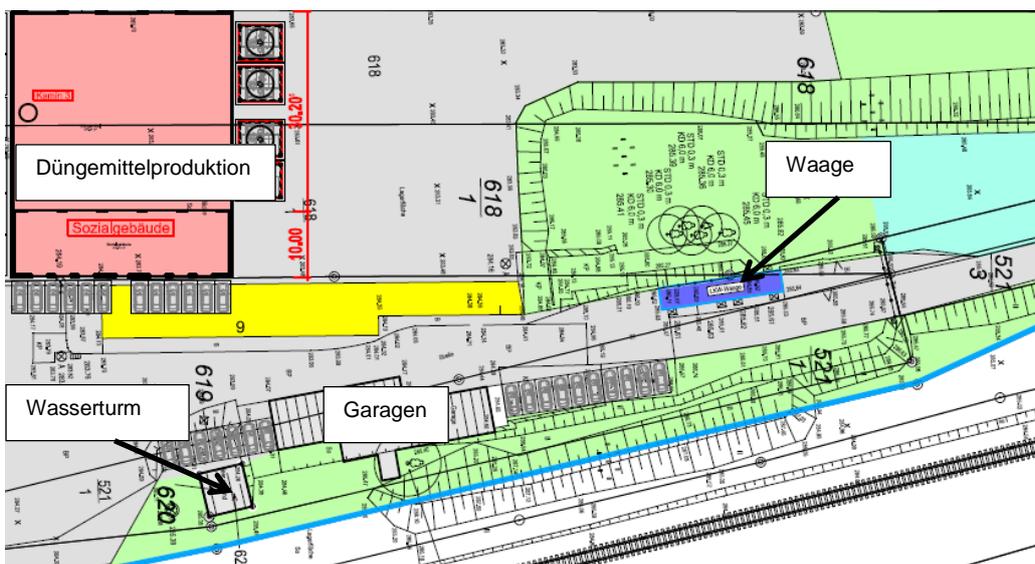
Auszug aus dem Lageplan (IBV Ingenieure)
